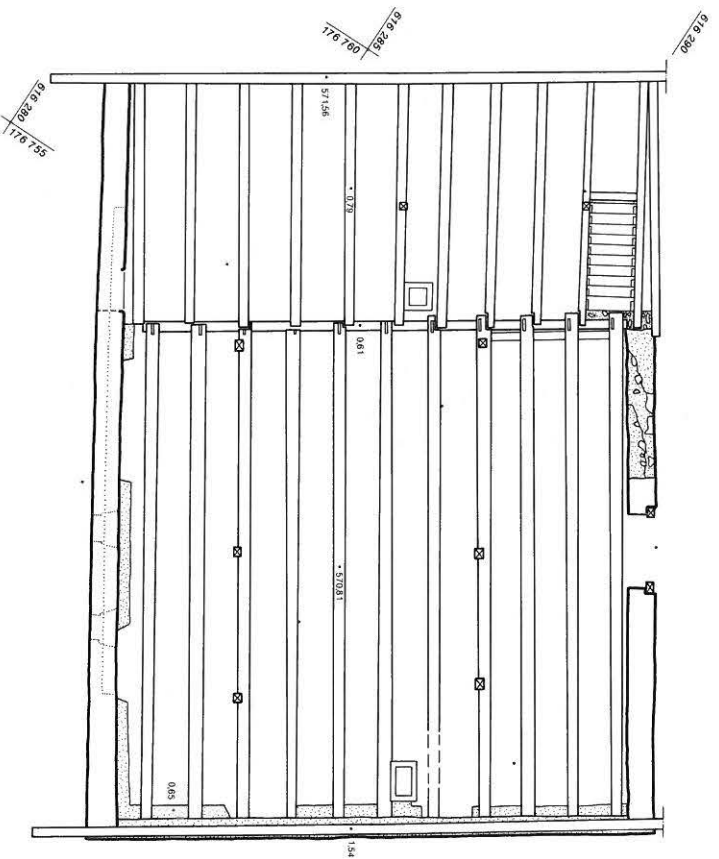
Grundriss des Dachgeschosses. M. 1:150.
